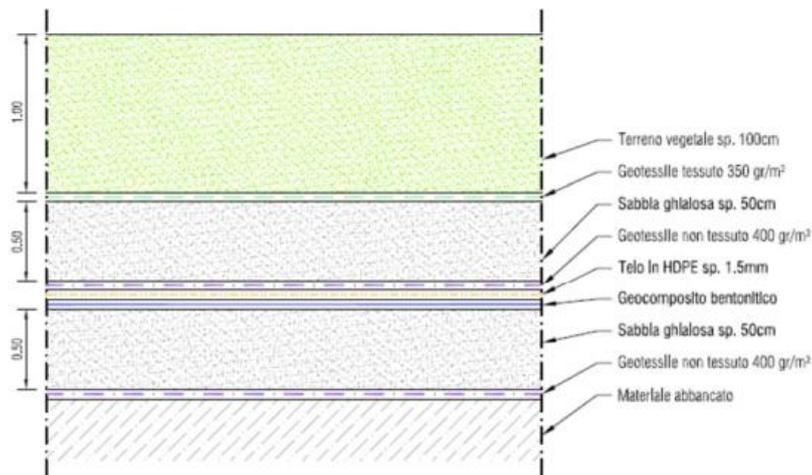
Stralcio progettuale relativo alla stratigrafia del pacchetto di copertura tipo in corrispondenza delle aree subpianeggianti di allocazione con finitura a verde - E' presente l'indicazione dei vari strati di geotessili
